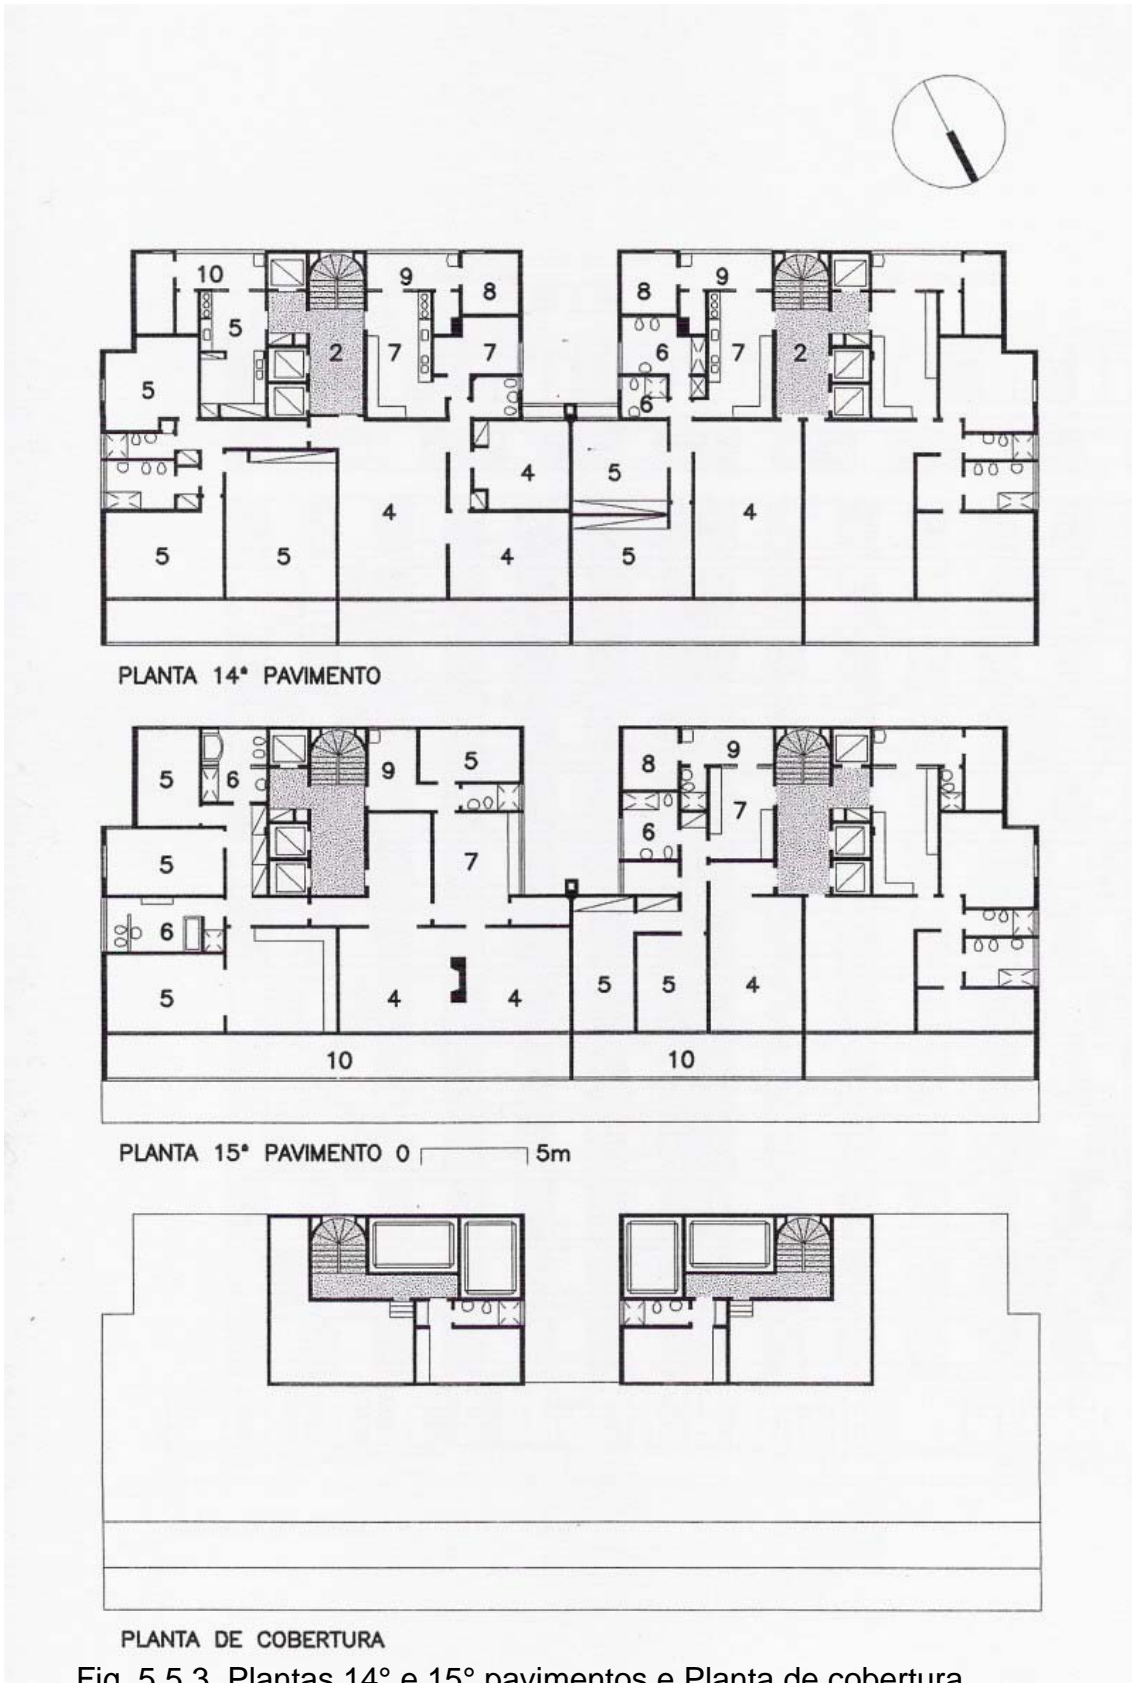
Plantas 14º e 15º pavimentos e Planta de cobertura.
